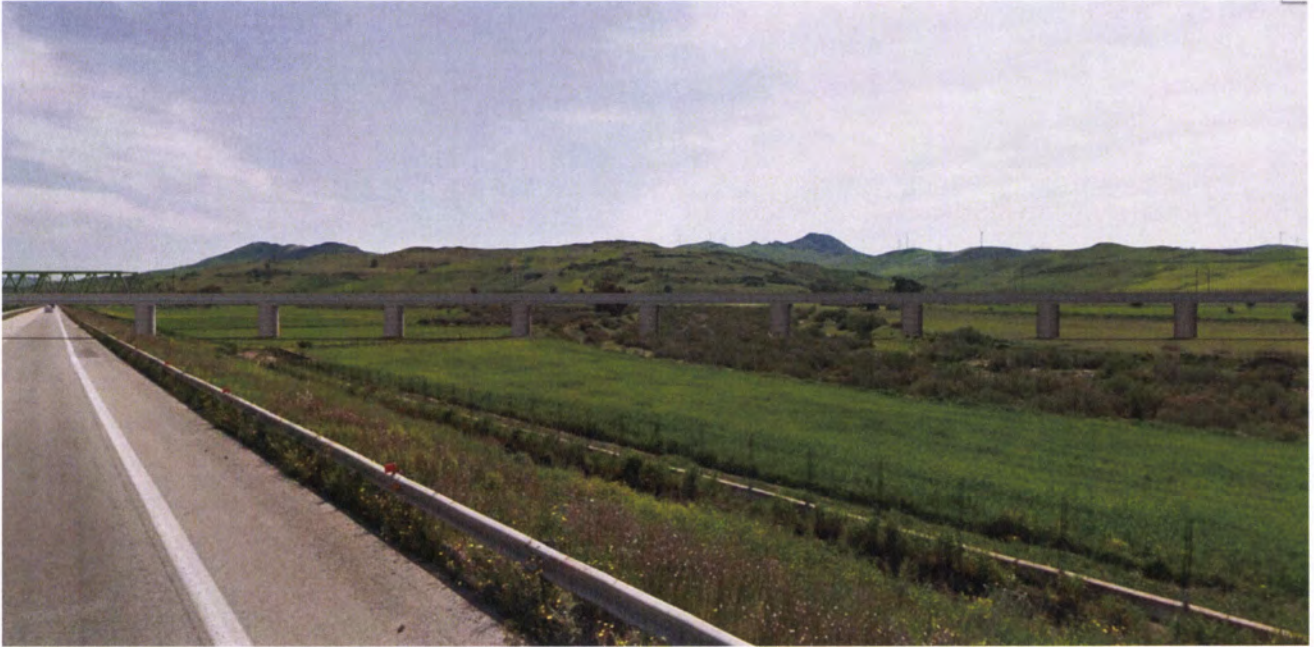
Situazione post-operam: pile impalcati in cls e traverse reticolari verde.
